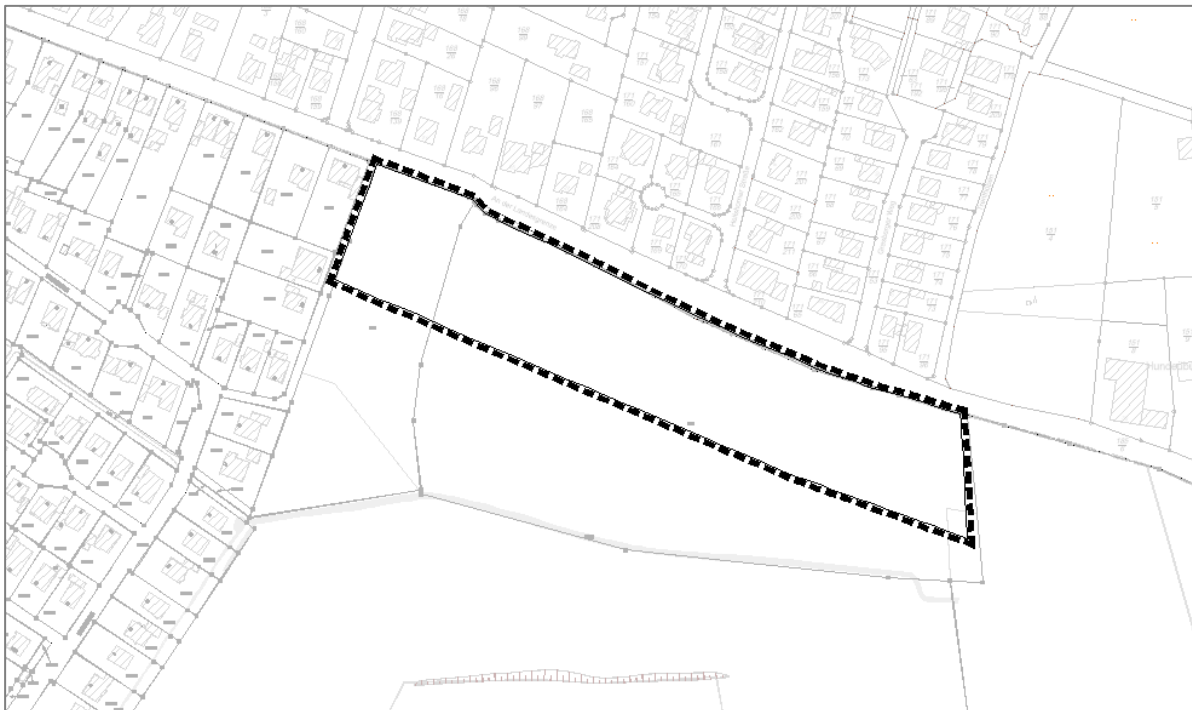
Lageplan mit Plangebiet des Bebauungsplans 1627 (ohne Maßstab; Quelle: GeoInformation Bremen)
